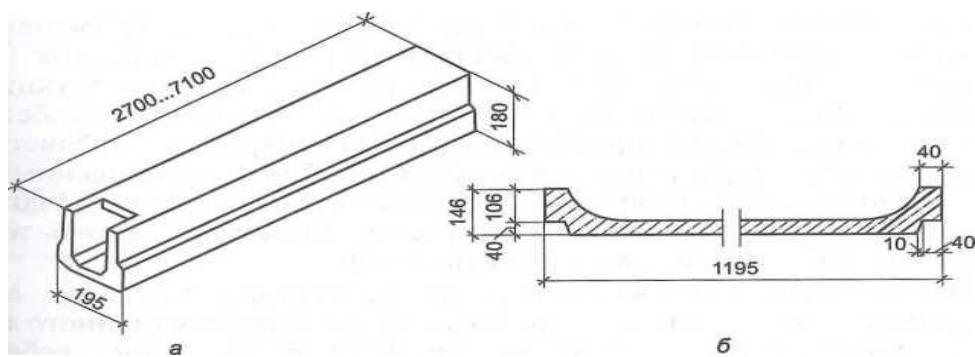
Железобетонные вкладыши для устройства сборно-монолитных междуэтажных перекрытий:
